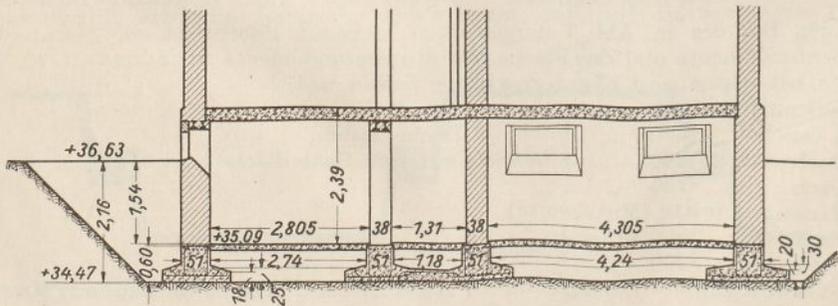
Gründung auf einem Eisenbetonplattenrost.
